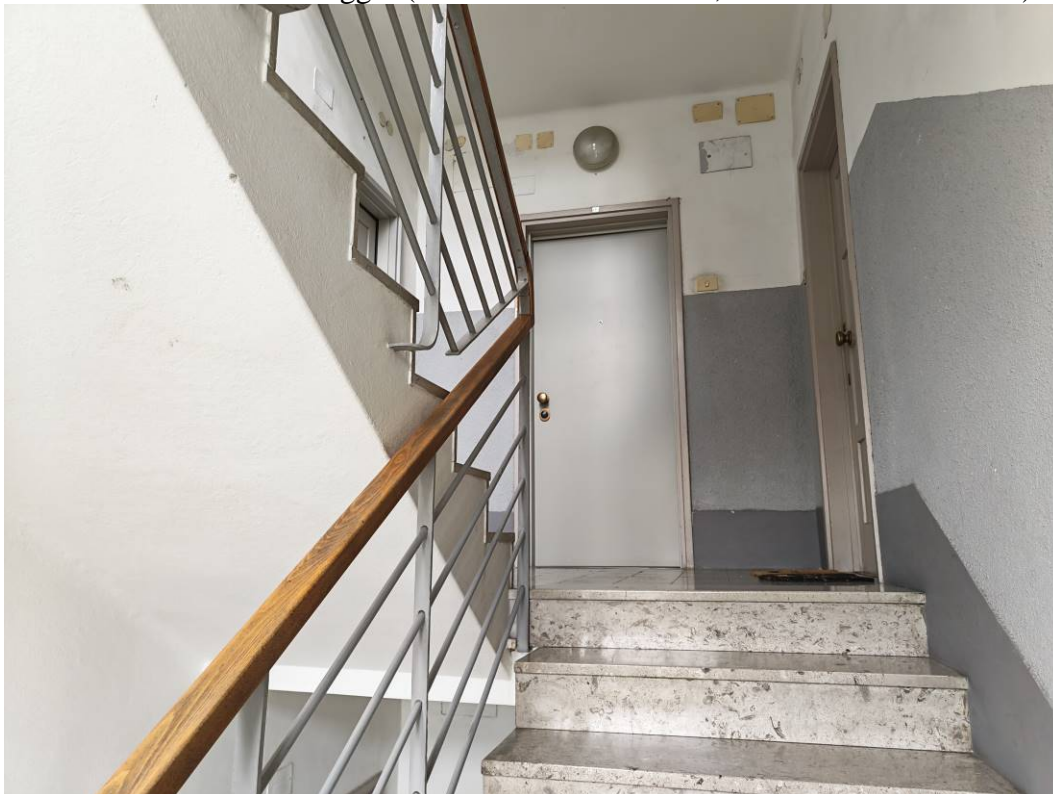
Pianerottolo del terzo piano; in primo piano la porta blindata che consente l’accesso all’alloggio (unità condominiale “8”, subalterno catastale 13)
